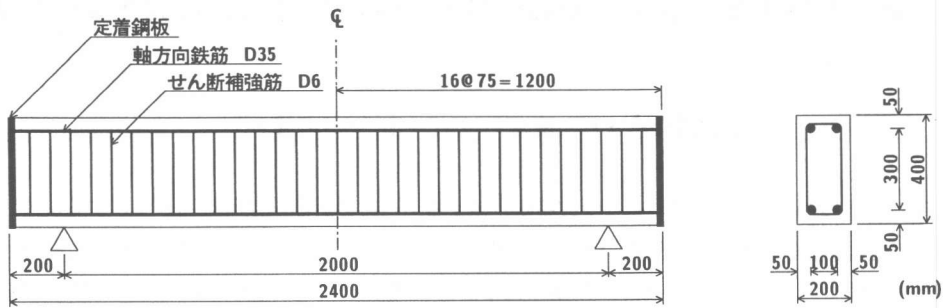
RC梁の形状寸法と配筋状況の一例 (S4梁)
